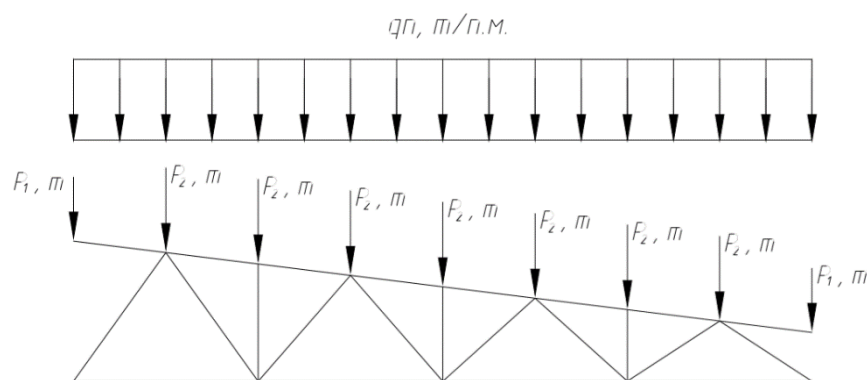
Схема приложения нагрузки от веса покрытия
